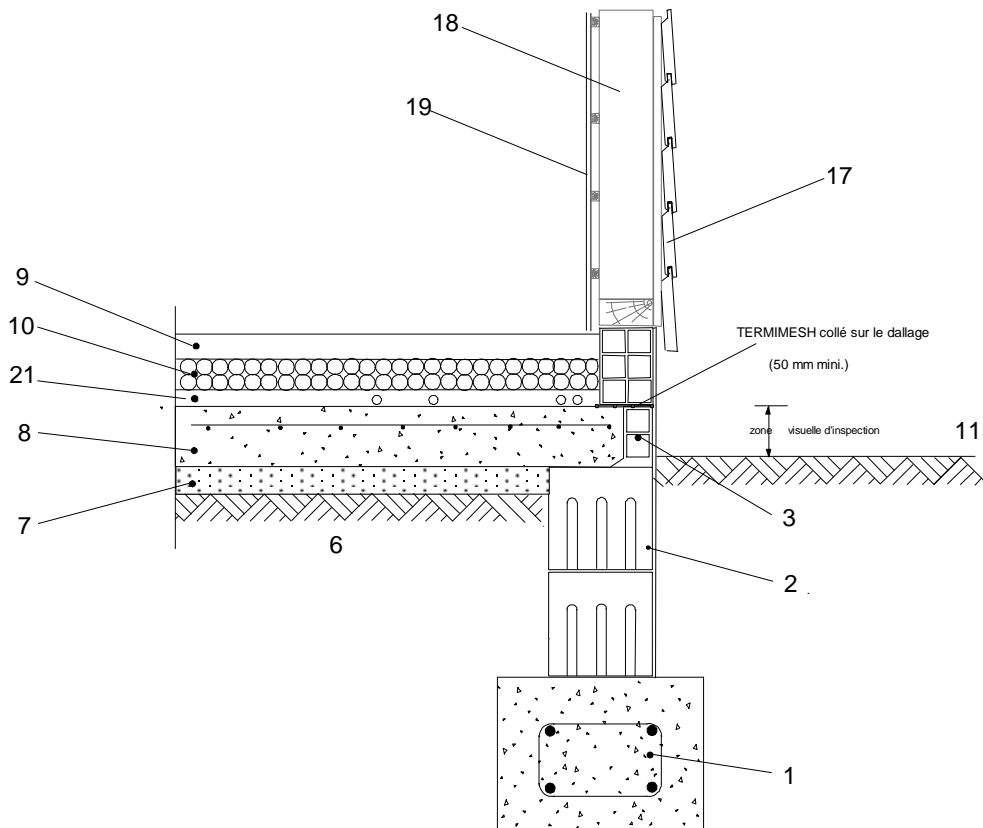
EU 1.1-6_ dallage-ossature-bois-planelle-béton-rehaussé
